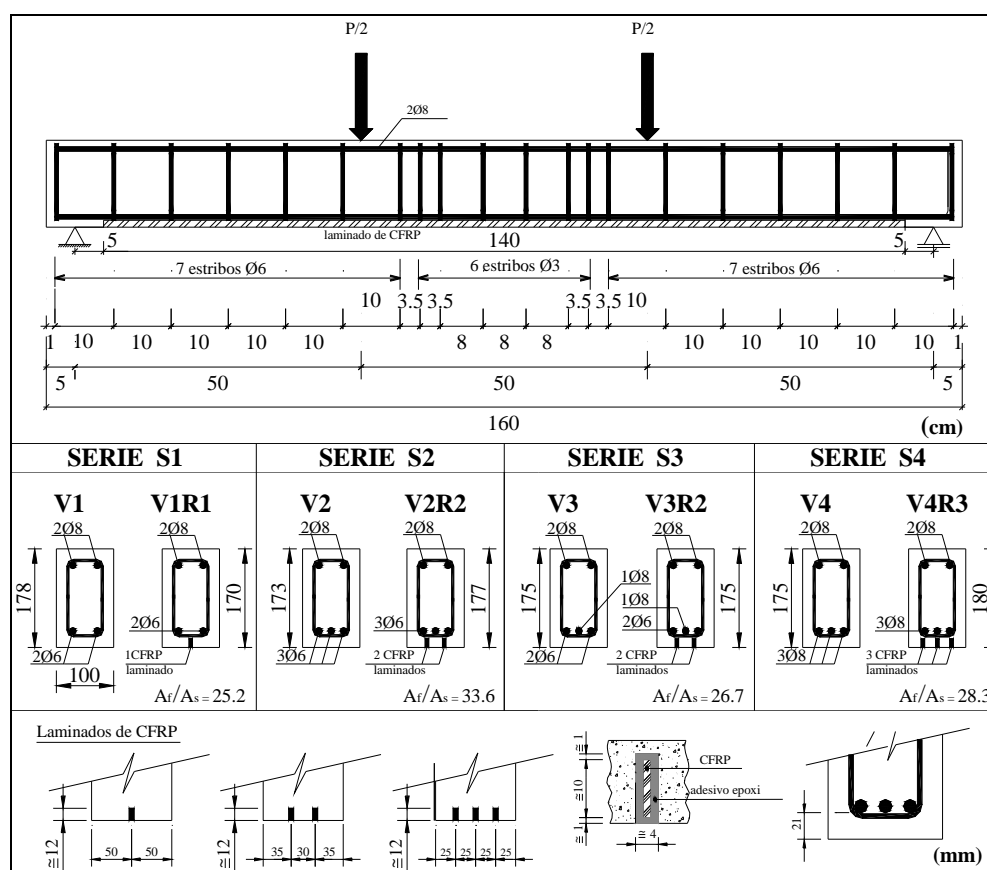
Aplicação da técnica NSM com laminados de CFRP no reforço à flexão de vigas de betão armado (dimensões em milímetros) (Fortes *et al.*, 2002).
